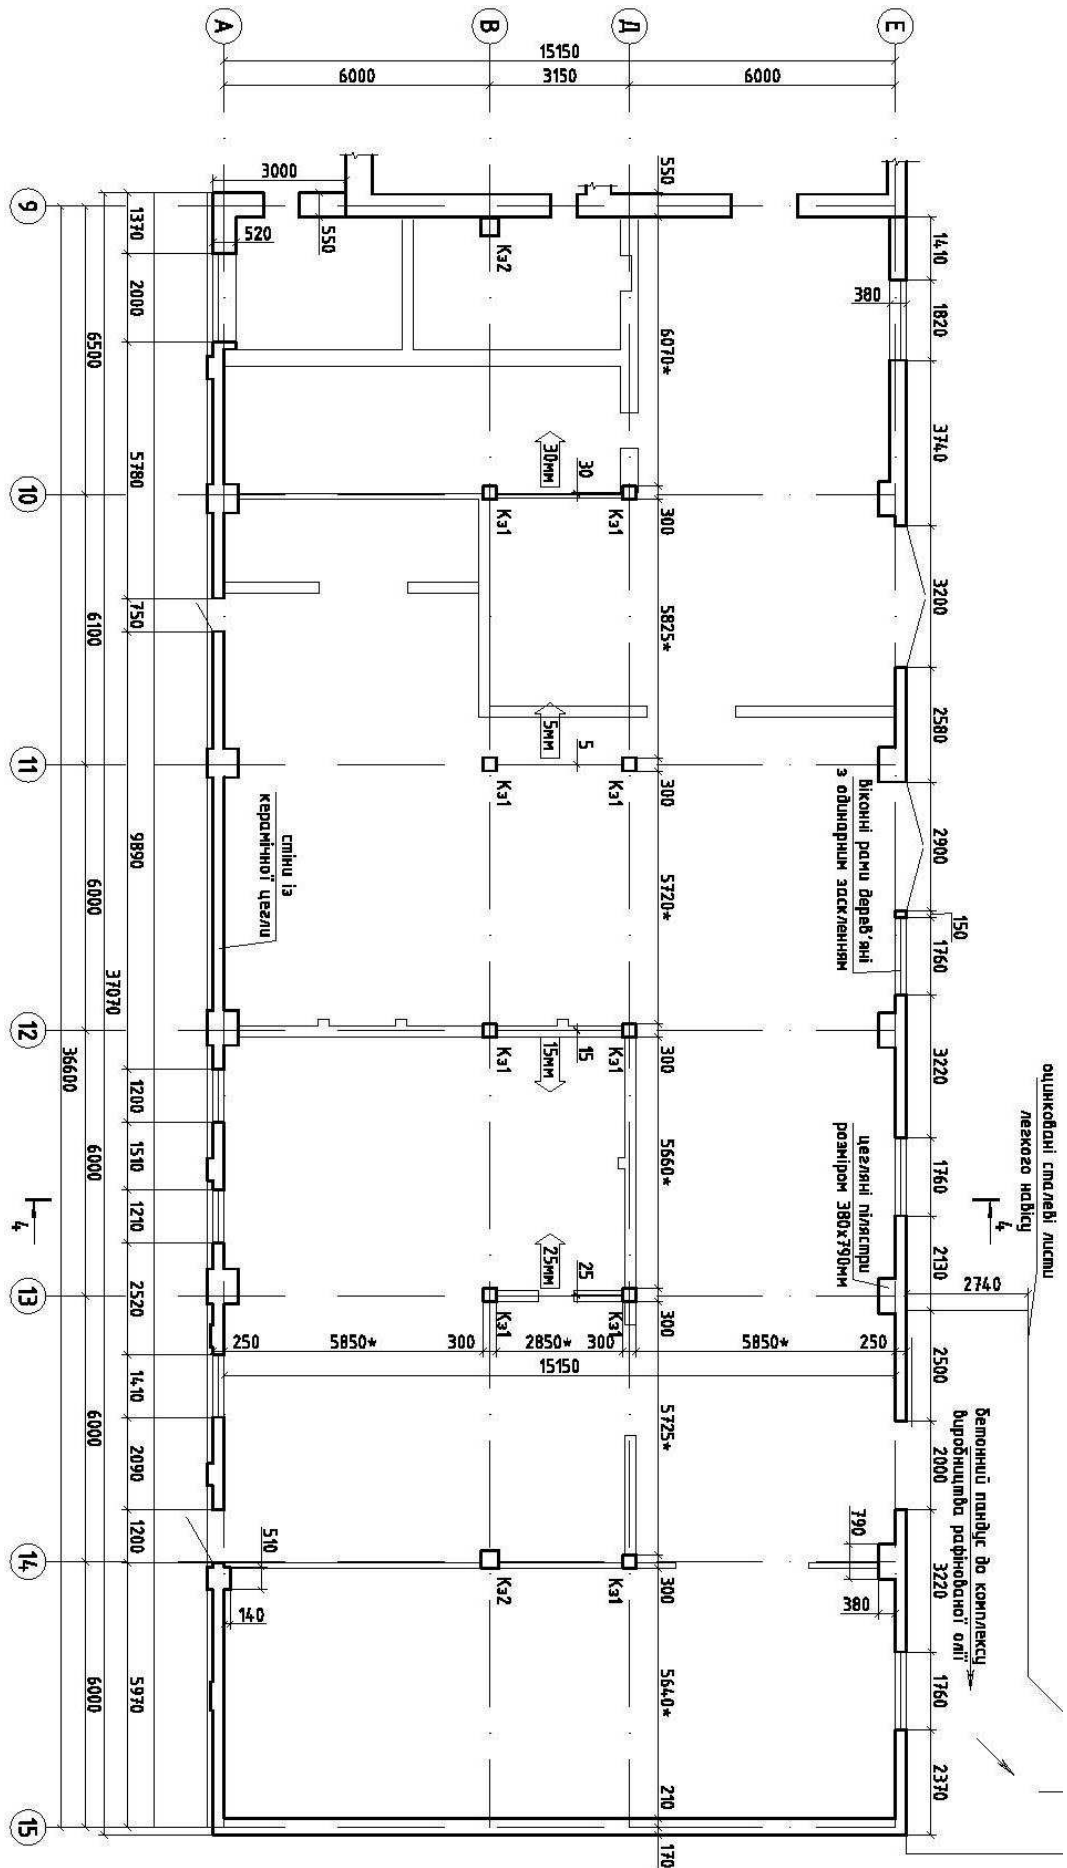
План на відм. 0,000 будівлі цеху фасування, складу тари в осях 9-15/А-Е
